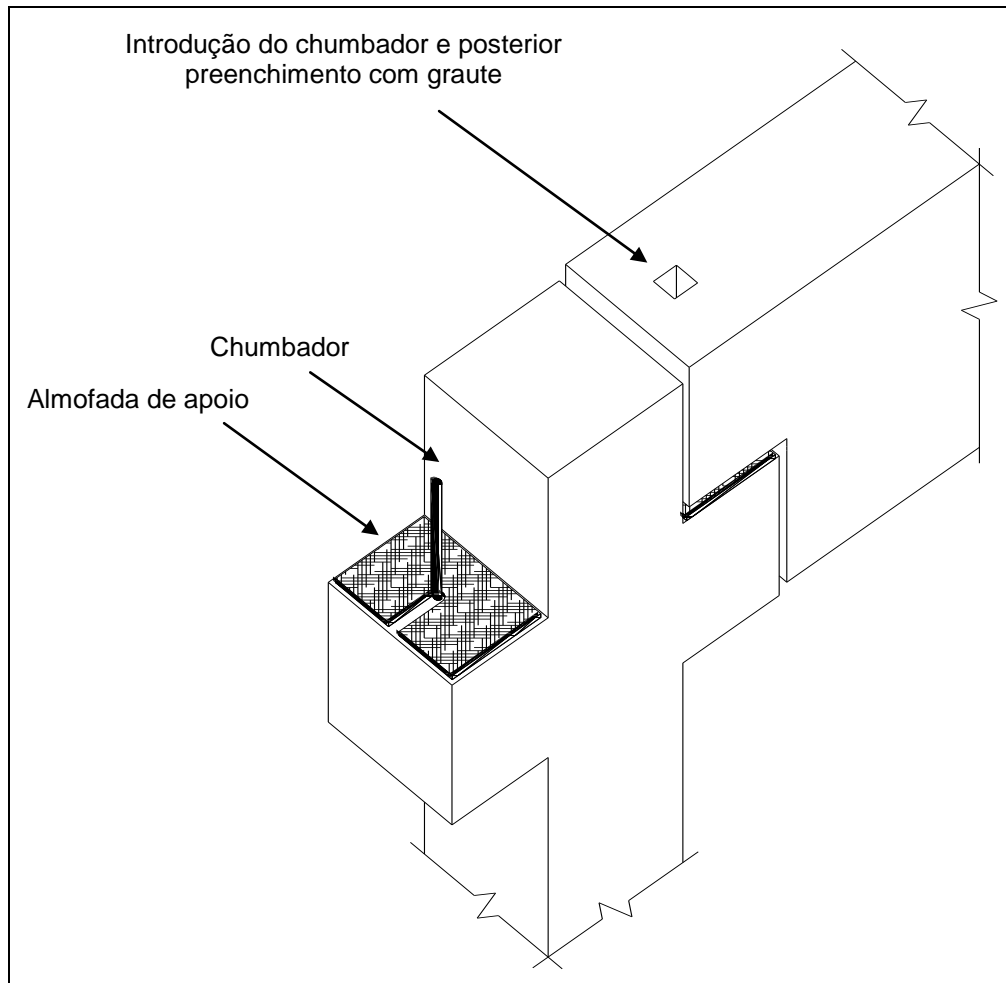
Exemplo de ligação viga-pilar (Adaptado de FIB, 2008)
